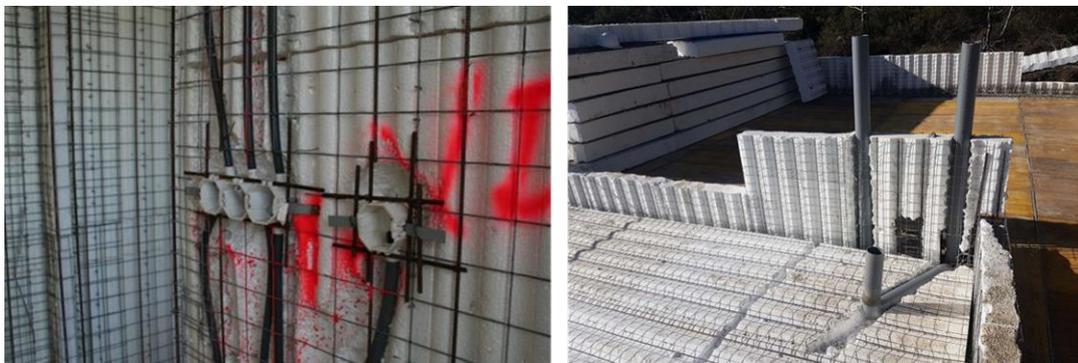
Pormenor construtivo de instalações embecidas em laje. Santoboís. 2023
